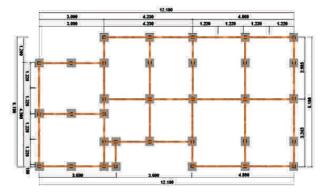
48 : Plano de vigas principales que amarran las cabezas de los pilotes, conformando el plano horizontal de la plataforma de madera.
